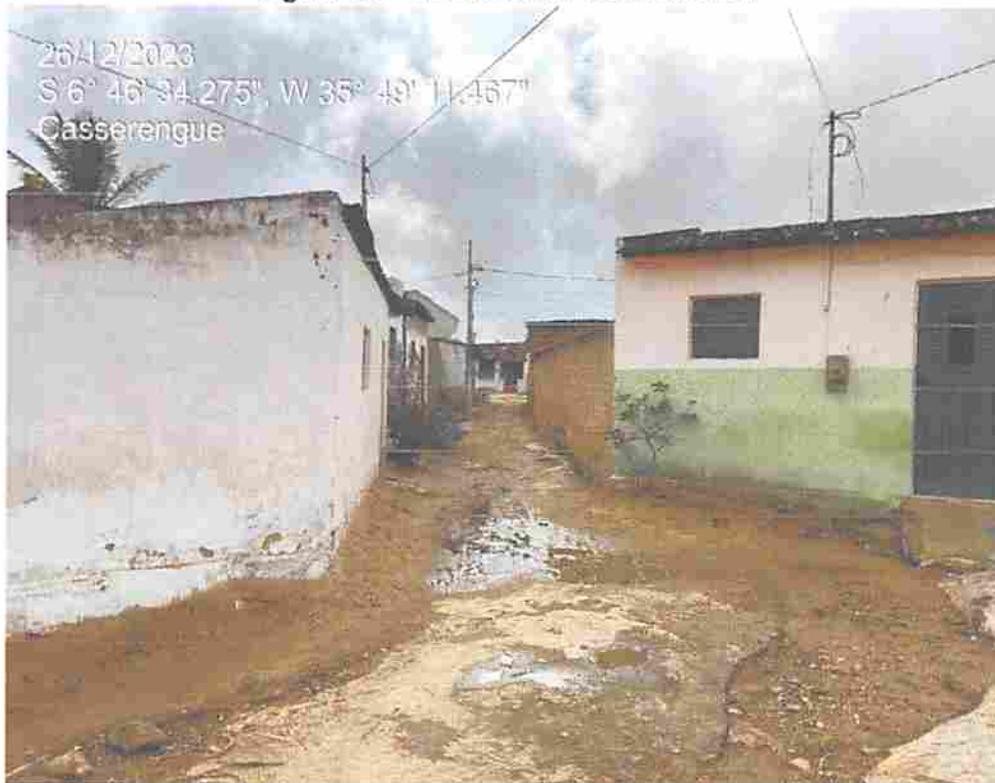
VISTA 01 DA TRAVESSA 01
